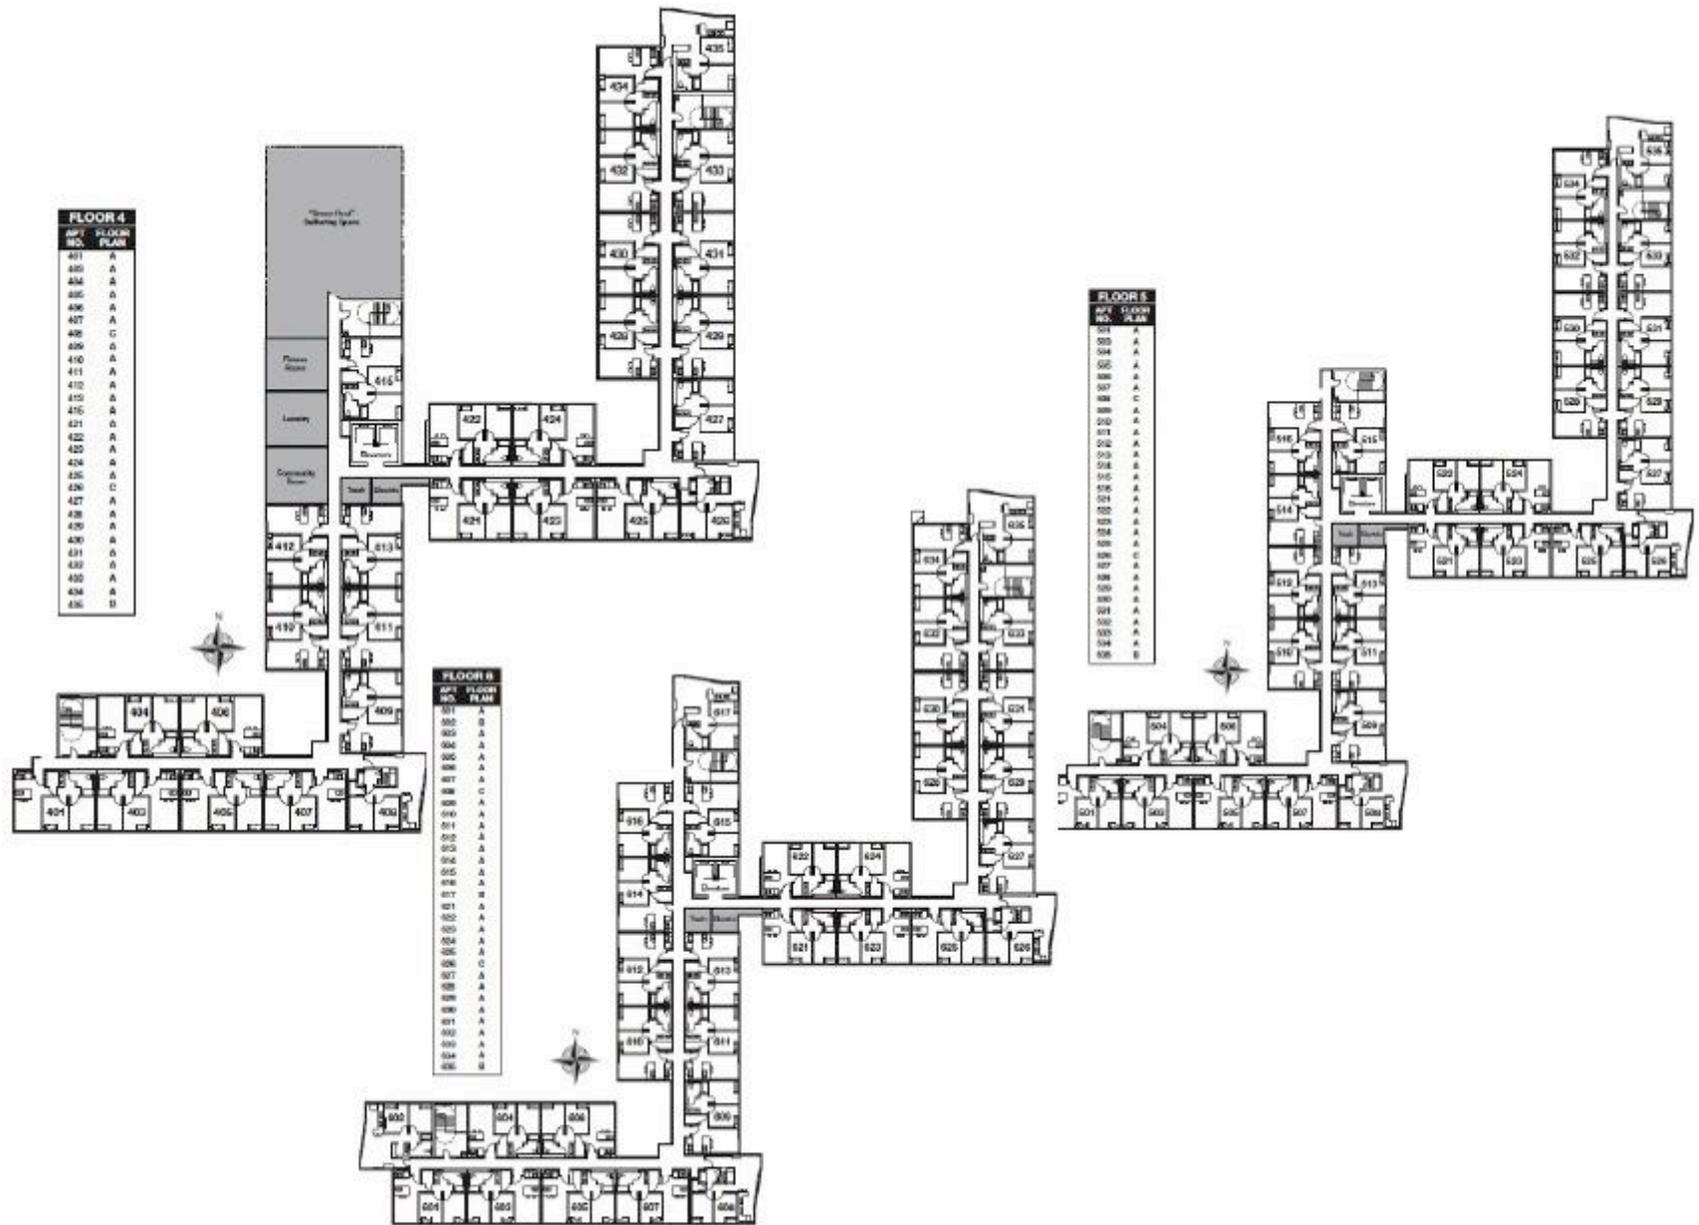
Planta arquitectónica nivel 4, 5 y 6.
